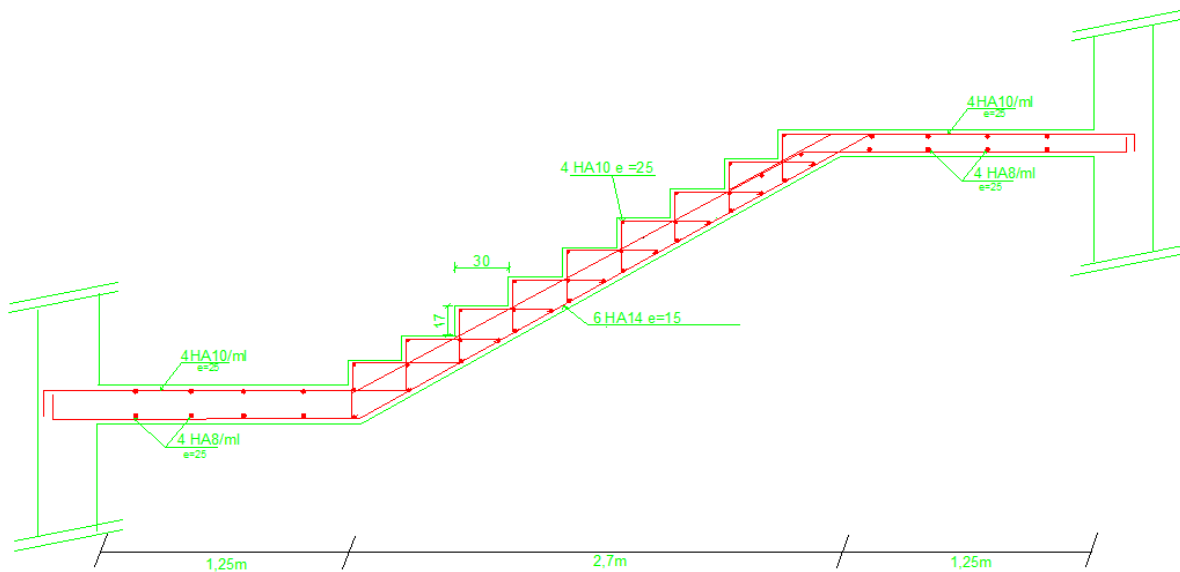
Plan de ferrailage 1^{er} volée d'escalier d'étage courant H=2,89m
